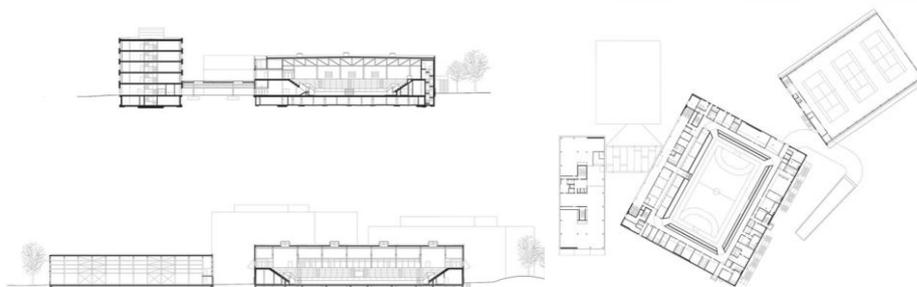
Fasade bangunan WIN4 Sports Centre
